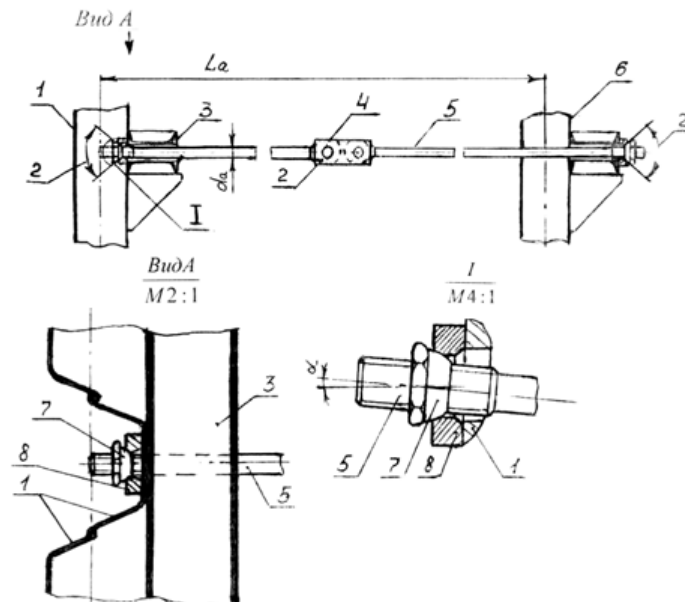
Конструкция шпунтовой стенки из шпунта «Ларсен» с анкерным креплением: 1 — лицевая стенка; 2 — шарнирное соединение; 3 — распределительный пояс; 4 — соединительные пластины; 5 — анкерная тяга; 6 — анкерная стенка; 7 — сферическая гайка; 8 — несущая плита распределительного пояса
